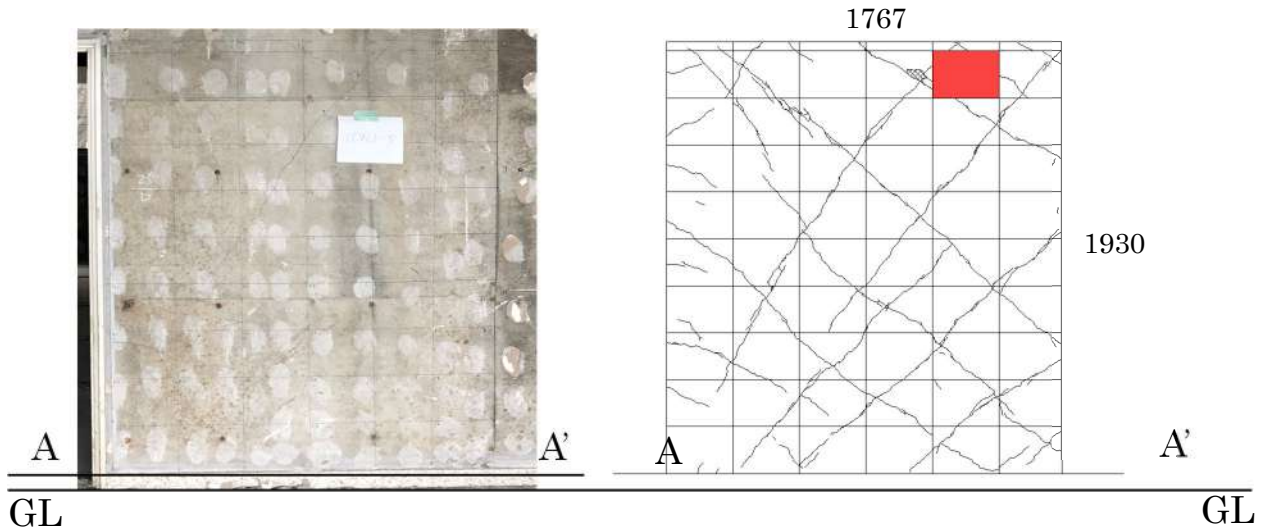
1CW3-5 のひび割れ図
